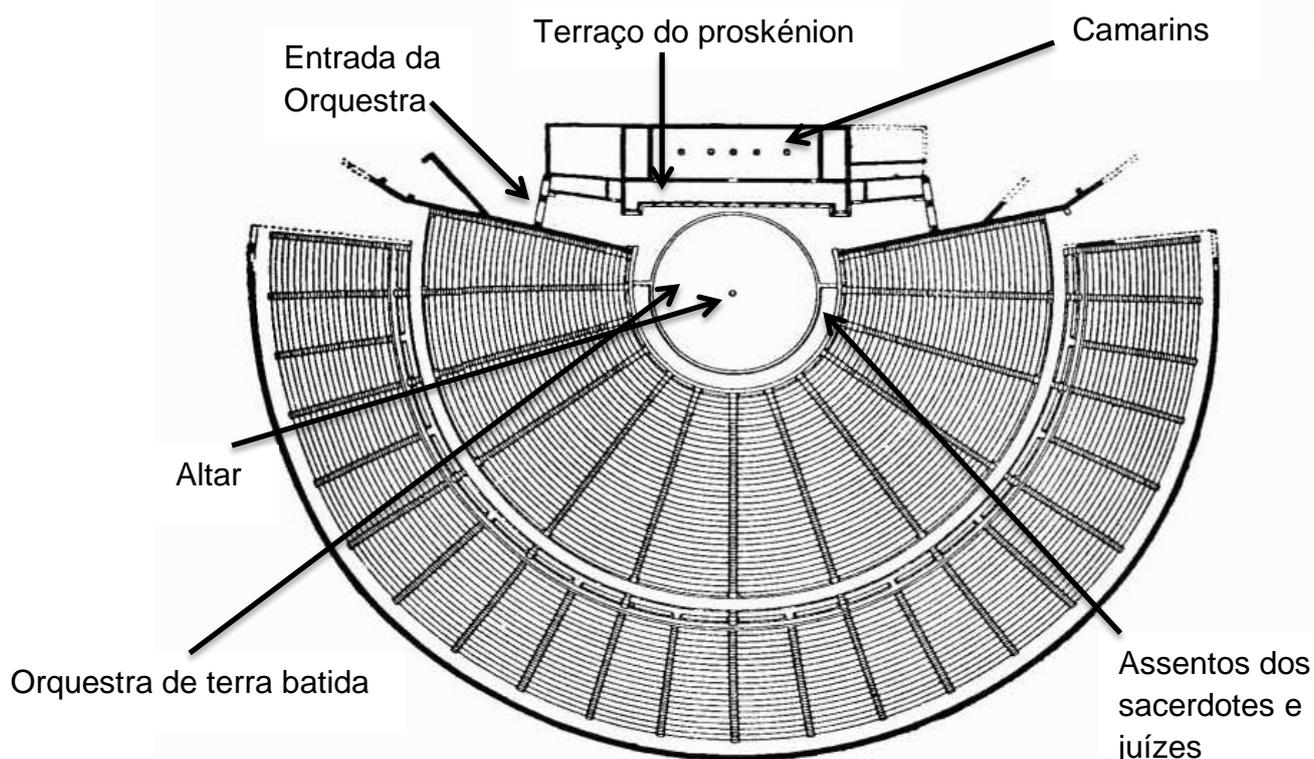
Planta do teatro de Epidauro. Acervo: pessoal
